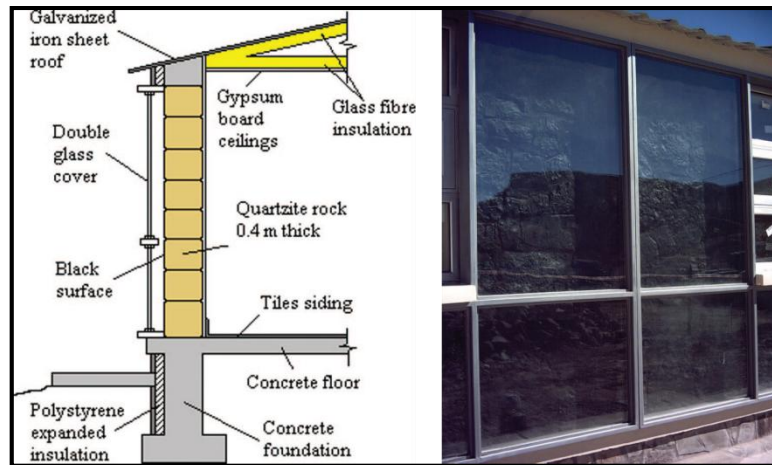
Détails du mur Trombe construit dans le secteur de l'hospitalisation.
